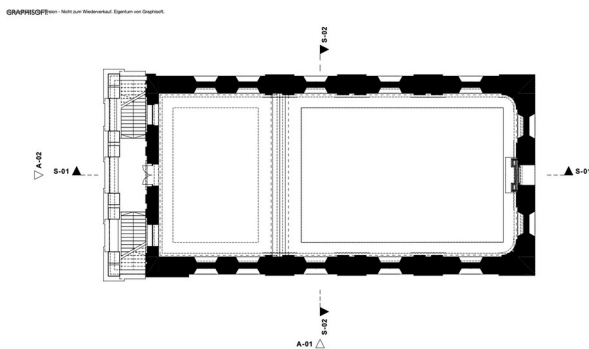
Rekonstruktion Grundriss 1. OG
